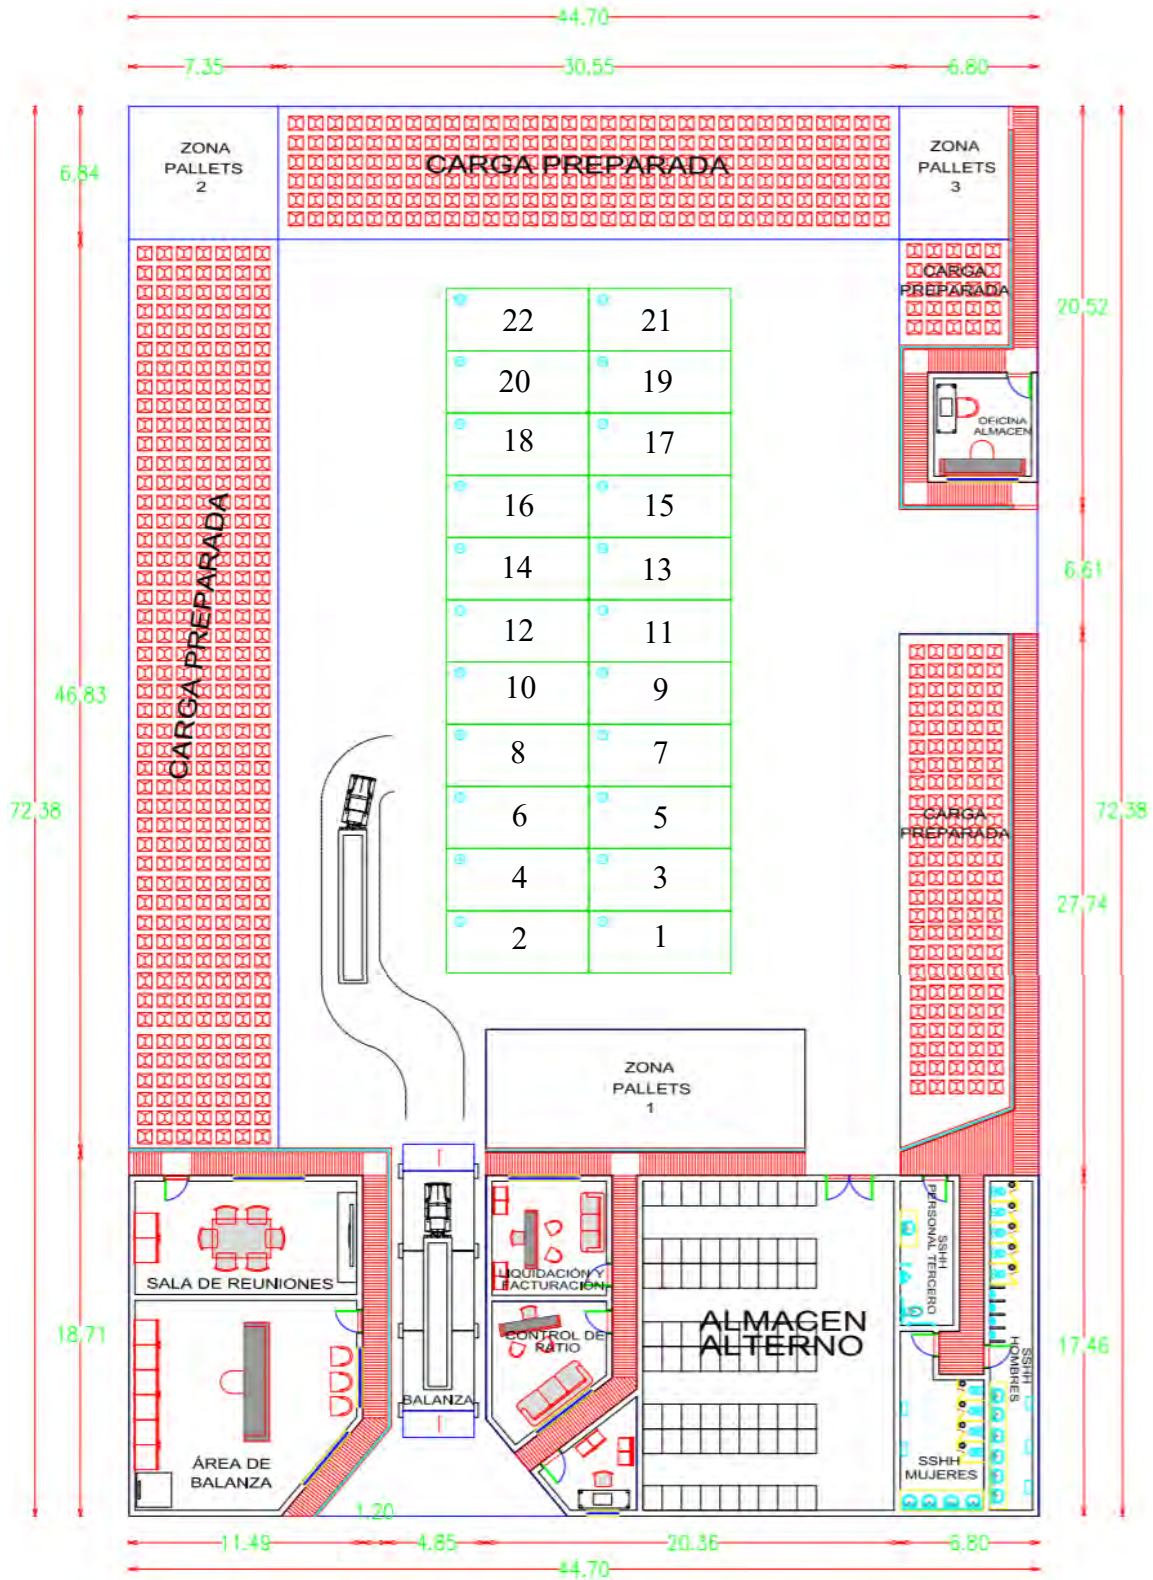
Layout propuesto del patio de maniobras de la planta principal
